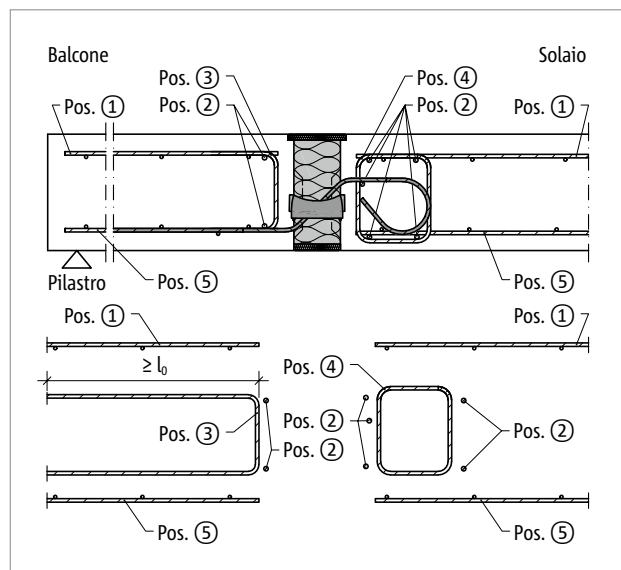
Schöck Isokorb® T tipo QL: armatura in opera
